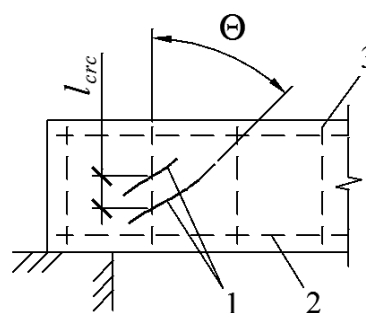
К определению расстояния между трещинами и угла наклона трещин: 1 – наклонная трещина, 2 – продольная арматура, 3 – поперечная арматура, 4 трещины, раздробление бетона в сжатой зоне.
